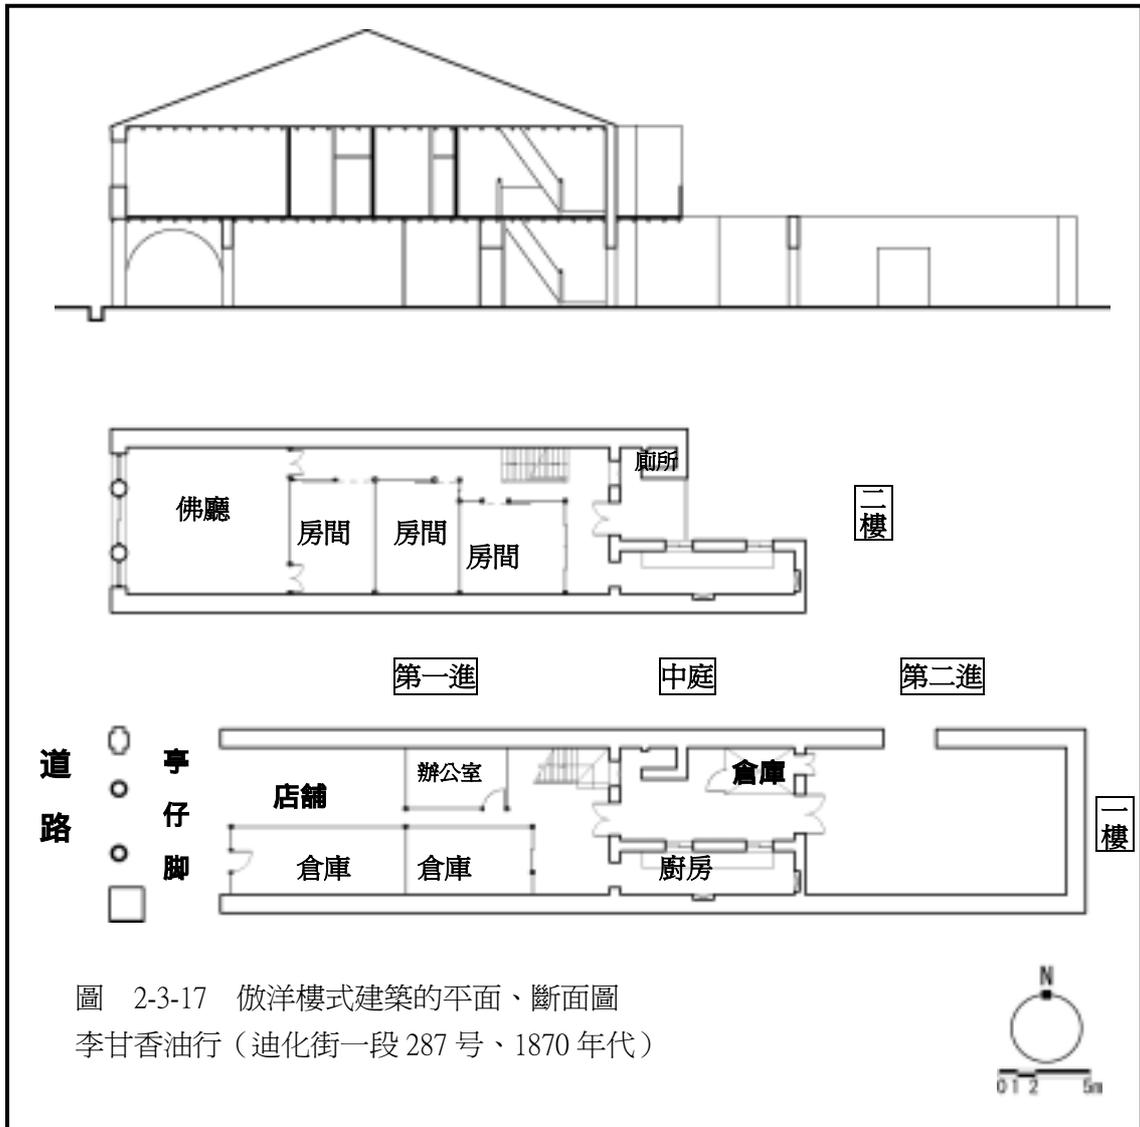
倣洋樓式建築的平面、斷面圖
